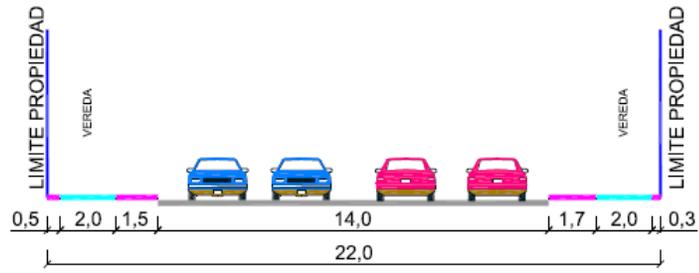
Perfil Tipo Av. San Martín, tramo Javier Carrera - Andes
